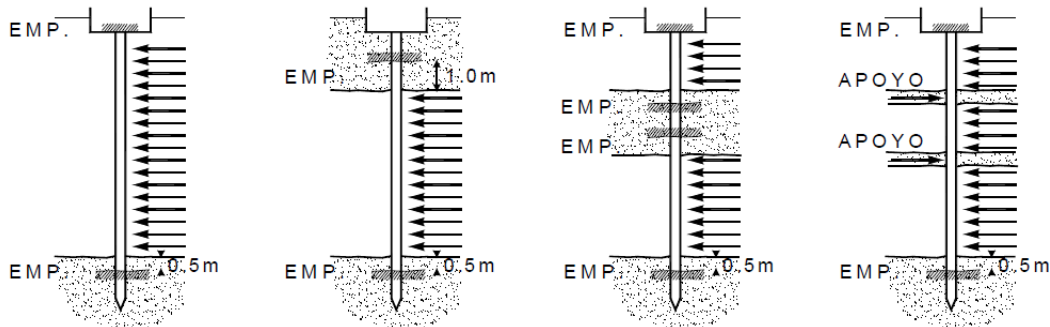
Condiciones de apoyo para el cálculo de esfuerzos en los pilotes
